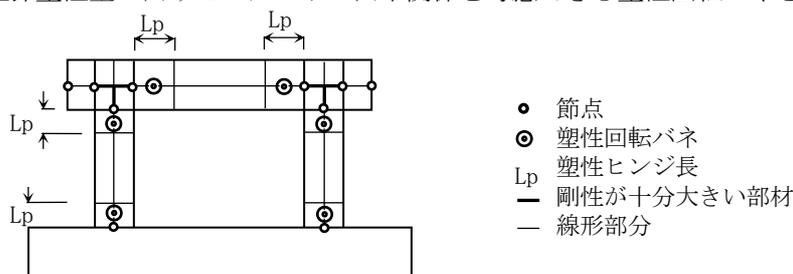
鉄筋コンクリートラーメン橋脚のモデル化
